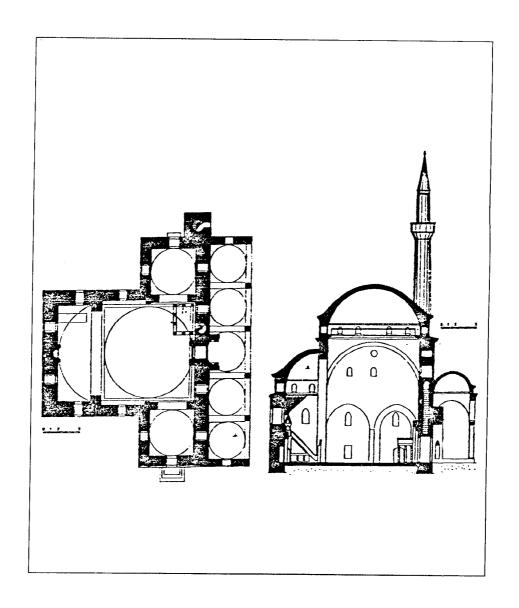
مكرر) مسقط أفقي لمسجد محمود باشا في إستانبول (عن : جودوين) .
